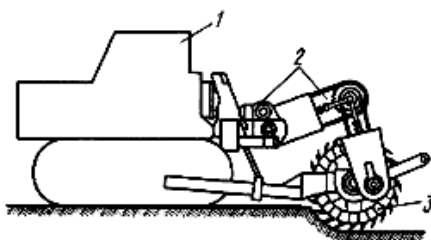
Дискофрезерная землеройная машина: 1 - трактор; 2 - система передачи и управления рабочим органом; 3 - рабочий орган машины (фреза).
